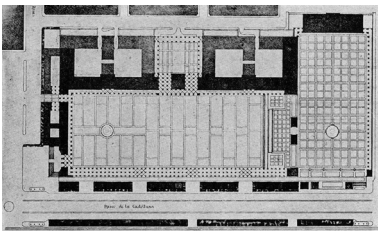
Plano general de planta de los Nuevos Ministerios.
